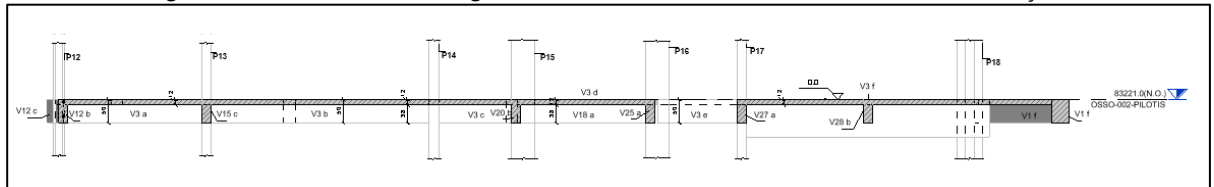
Detalhe da faixa de vista do Corte A-A da Planta de forma Pilotis.
